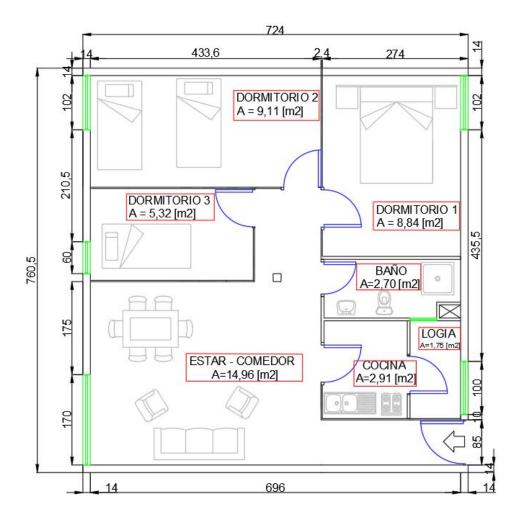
Planta arquitectura depto Tipo C2 replicada Autocad. Fuente: Elaboración propia.
